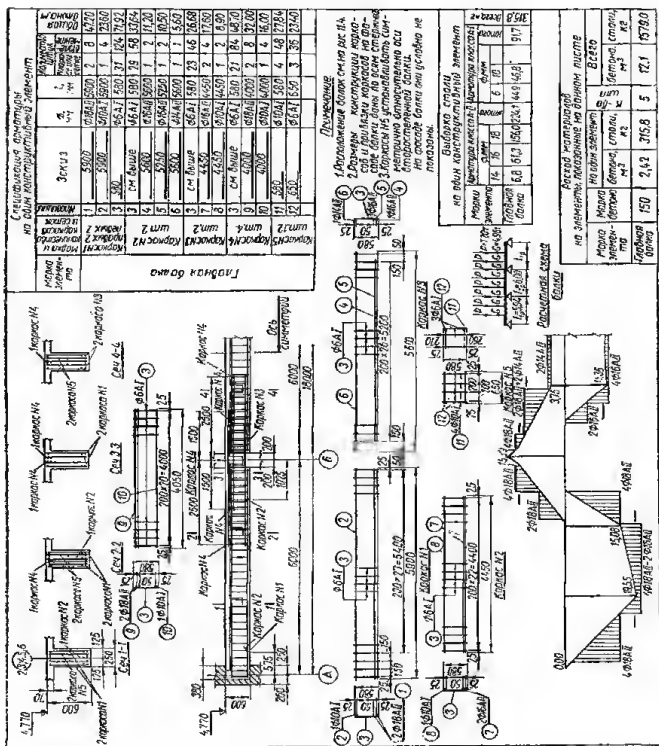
Армирование главной балки сварными каркасами.
